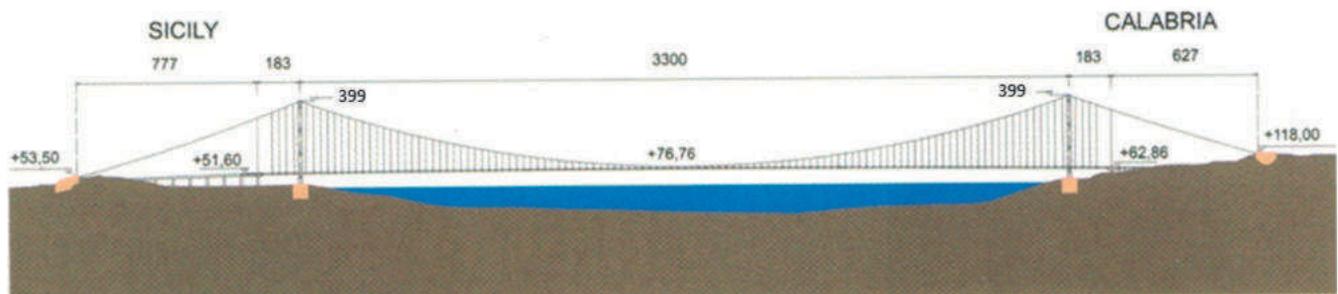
Sezione longitudinale del ponte progettato dalla Società Stretto di Messina [7].
